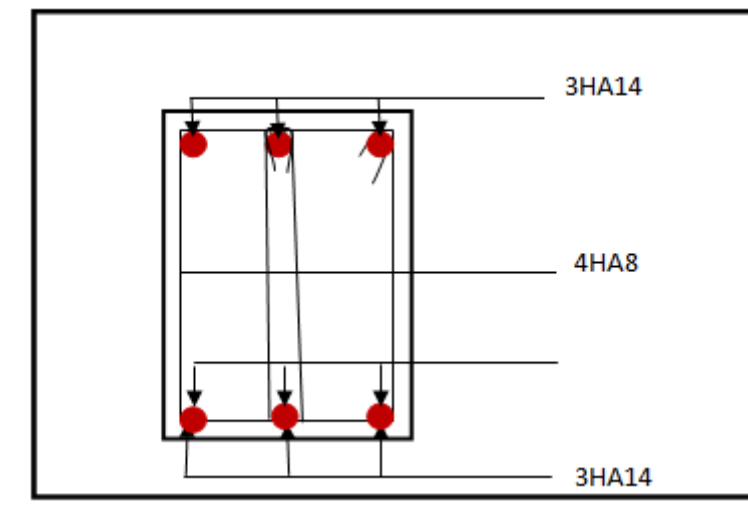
Ferrailage en travée d'une poutre secondaire.
